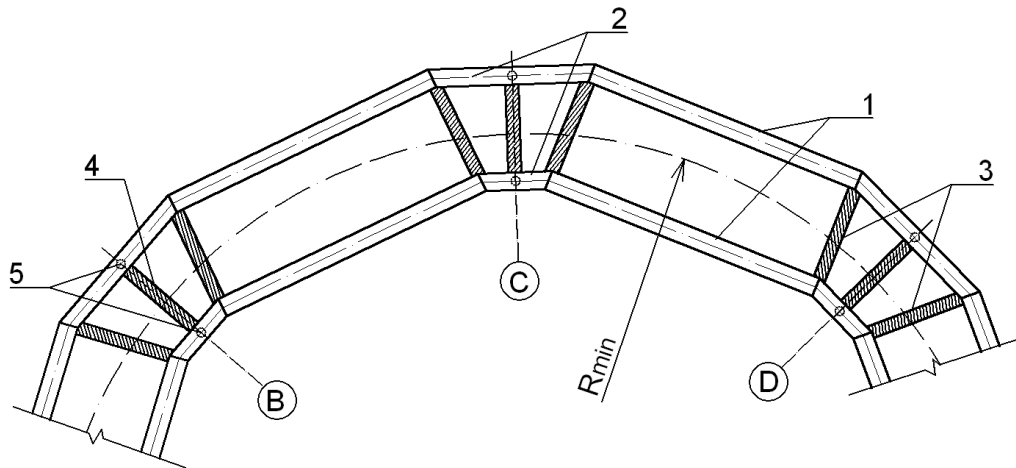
Формування нерозрізних головних балок по довжині: 1-прогонова збірна балка, 2- надопорна збірна або монолітна балка, 3-поперечна балка в зоні стику, 4-поперечна балка над опорою.
